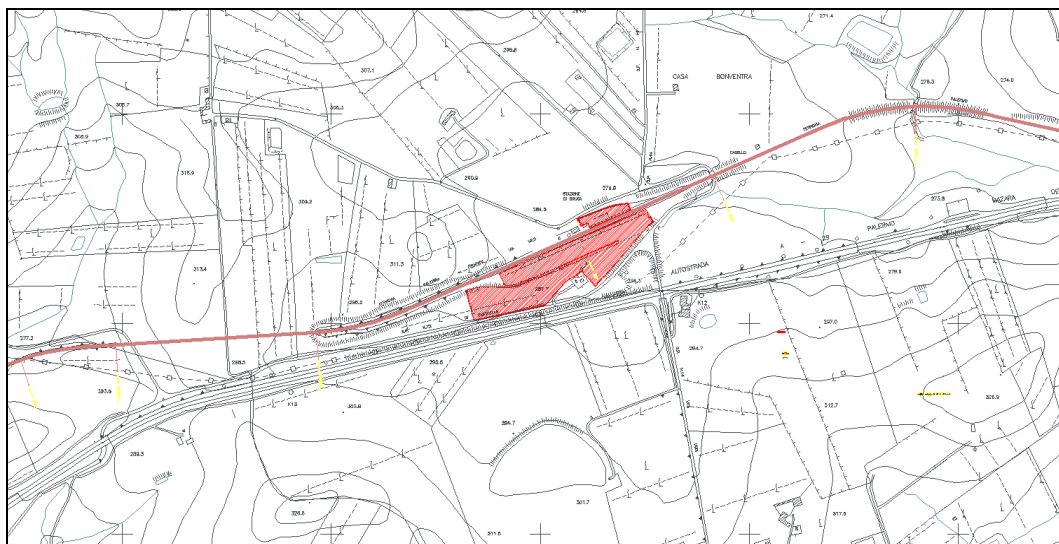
Cantiere per l'armamento stazione di Alcamo
